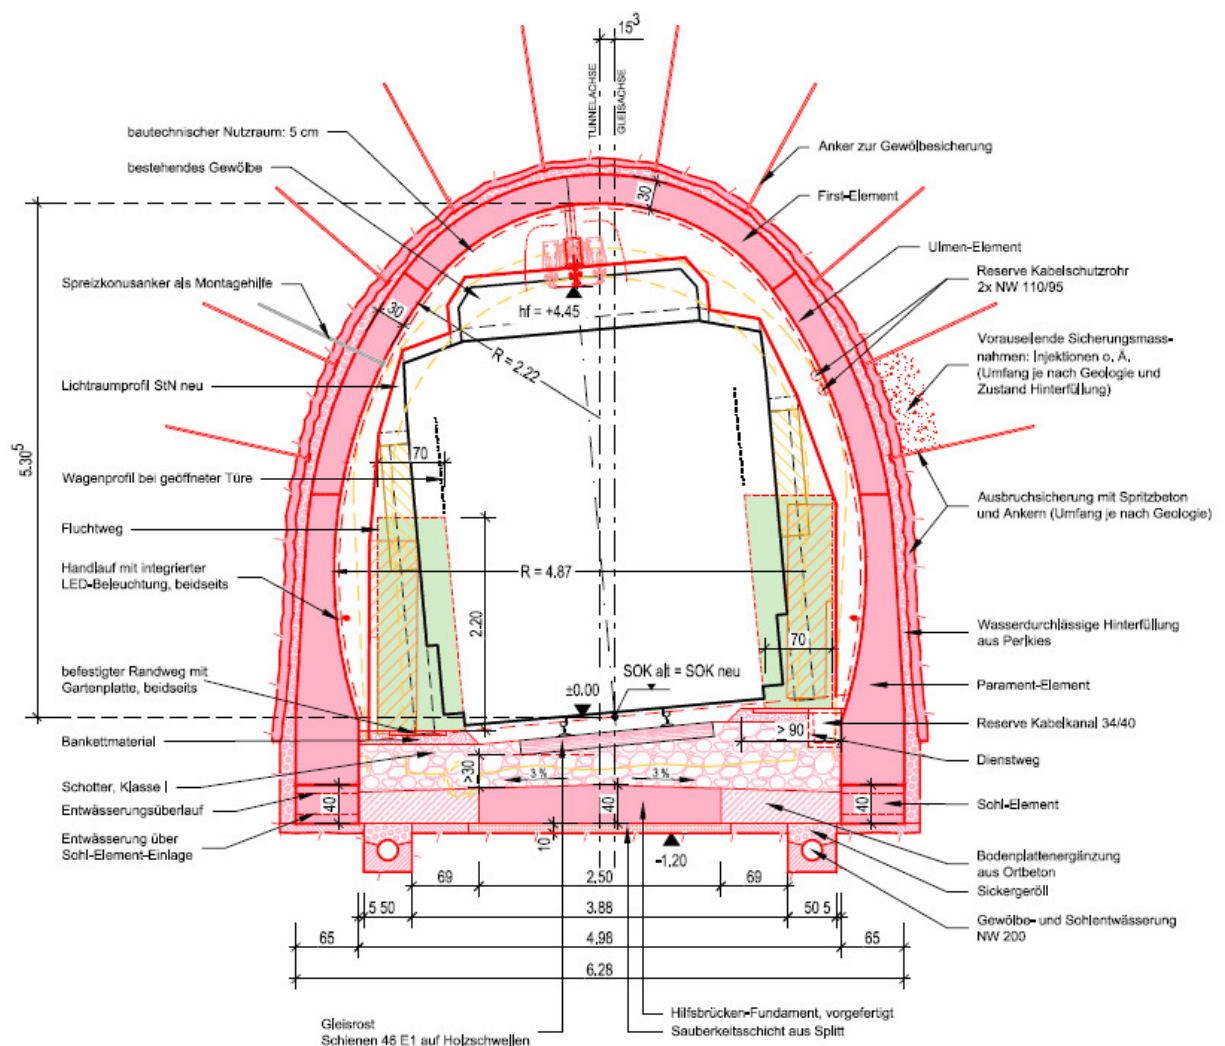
Normalprofil Bauprojekt Gletscherastunnel
